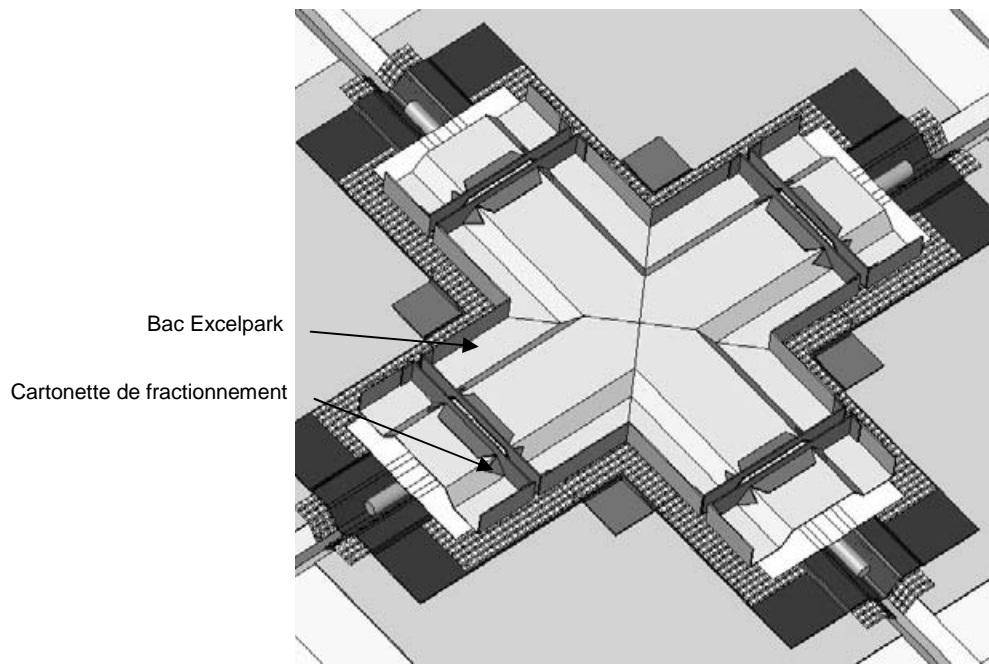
Croisement de joints EXCELPARK 1 / mise en œuvre des bacs de coffrage
